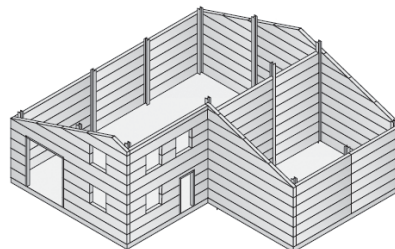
Принципиальная схема здания с горизонтальными панелями из автоклавного ячеистого бетона
